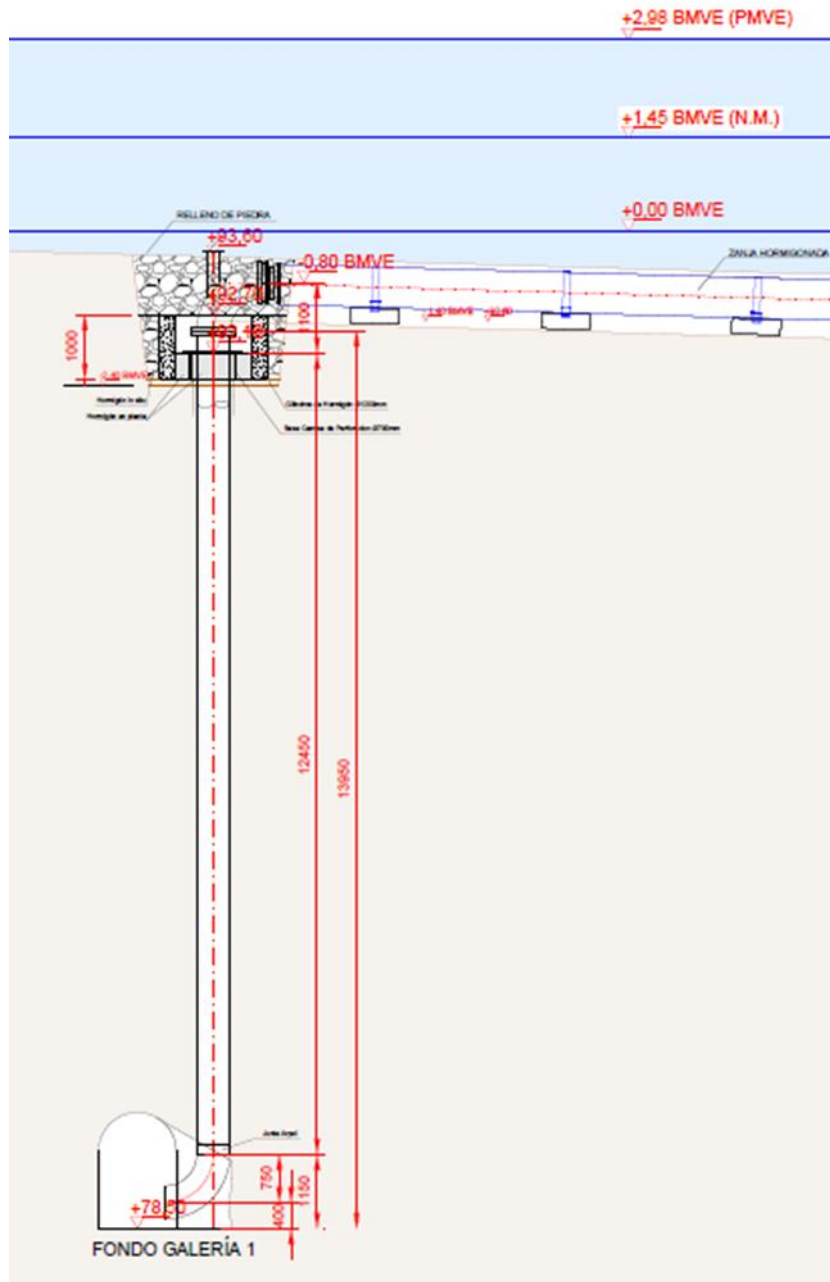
Sondeo de conexión de la conducción submarina a la Galería realizado
